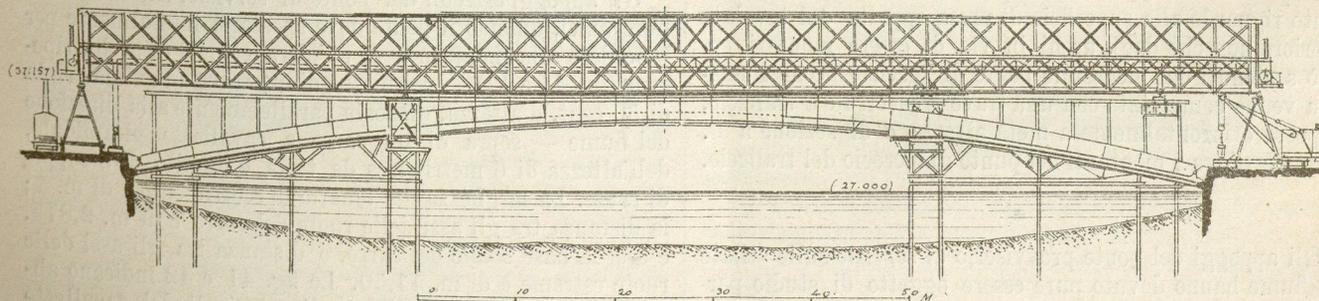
Prospetto del ponte di servizio scorrevole per la montatura degli archi.
